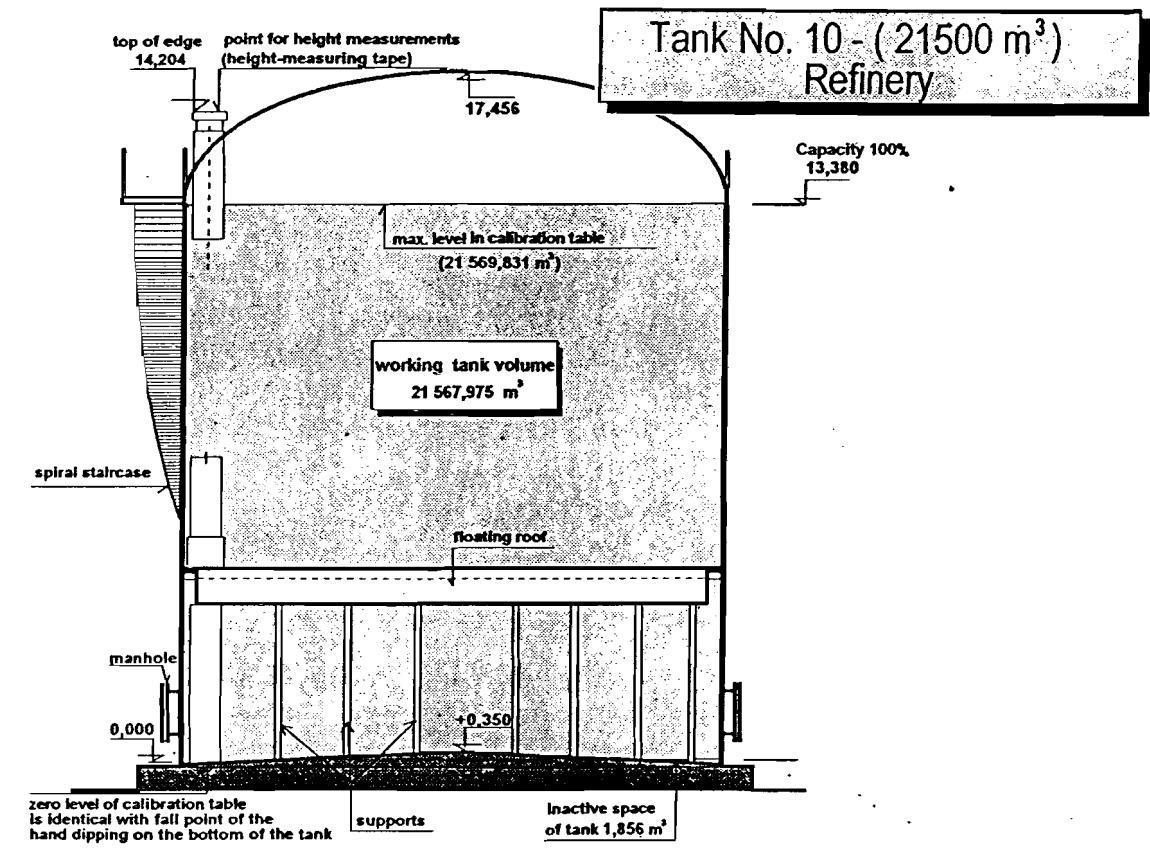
ถังสำรองชนิดผสมระหว่าง Fixed Roof กับ Floating Roof แบบ typical sandwich
